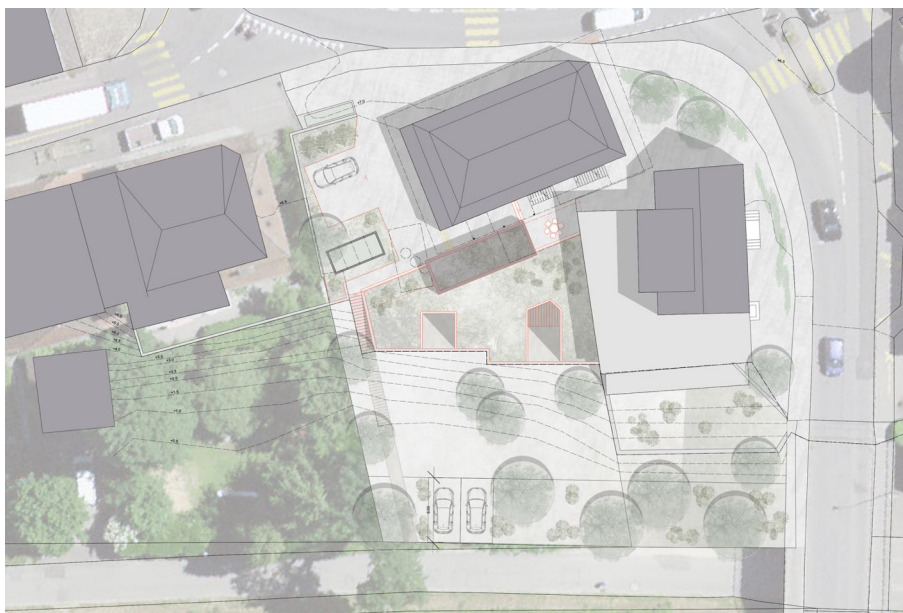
Situationsplan mit Terrainverlauf, Gartengestaltung und 2 Parkplätzen
